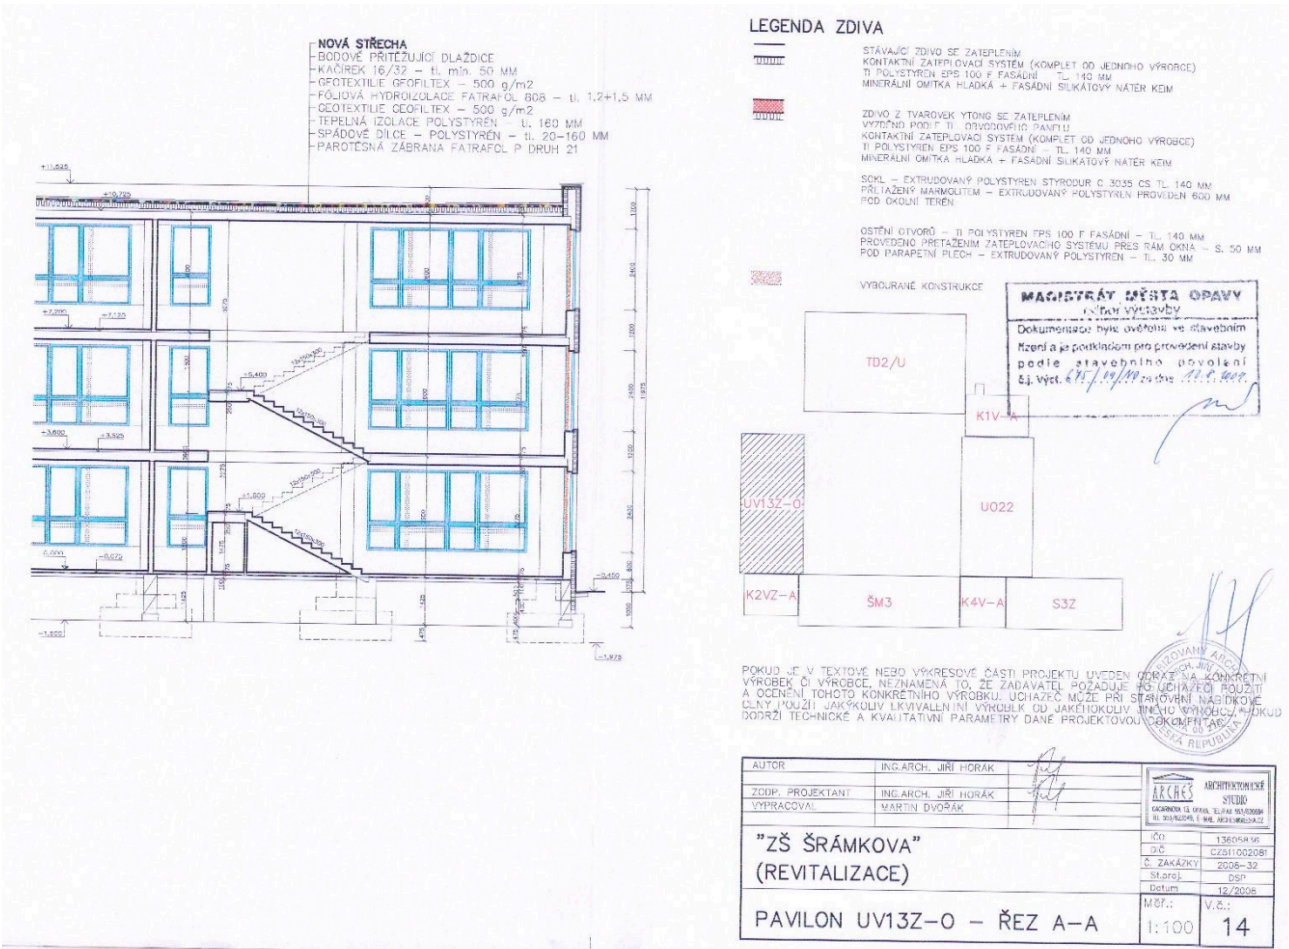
Střešní konstrukce z PVC krytinou a kačirkem
